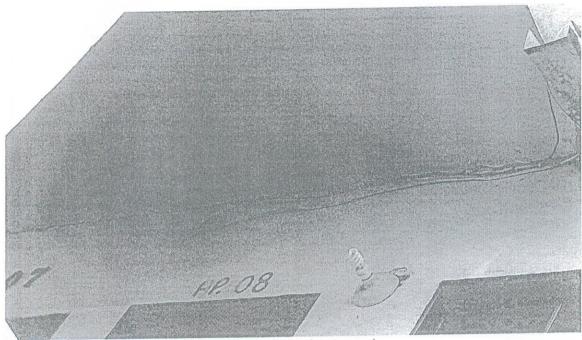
Fissura entre laje da caixa de escada e parede
